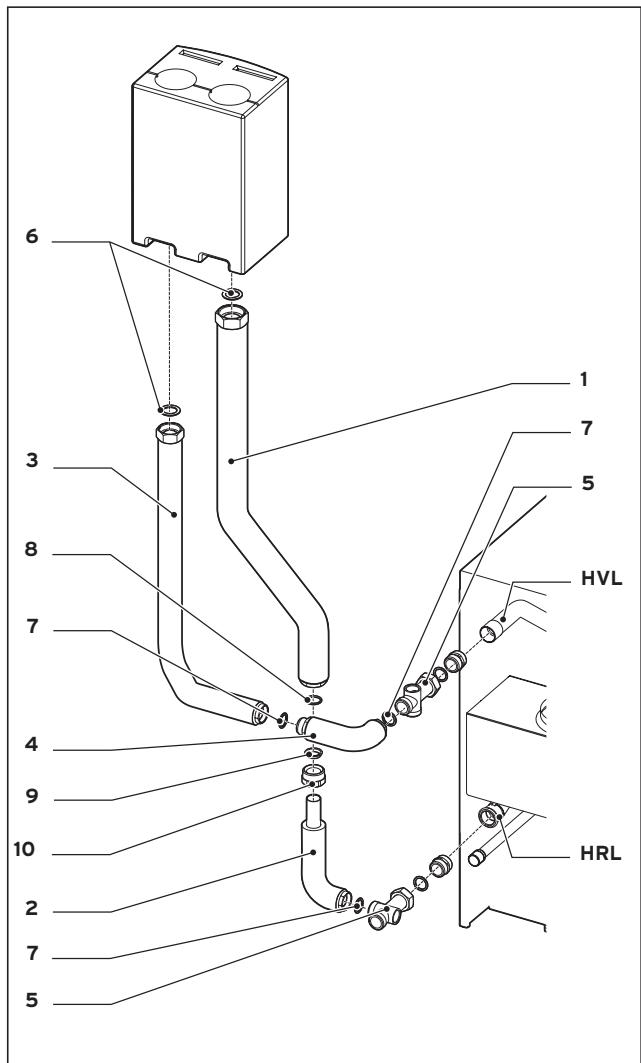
Montage der Anschlussverrohrung am atmovit exclusiv, quer zum Kessel
